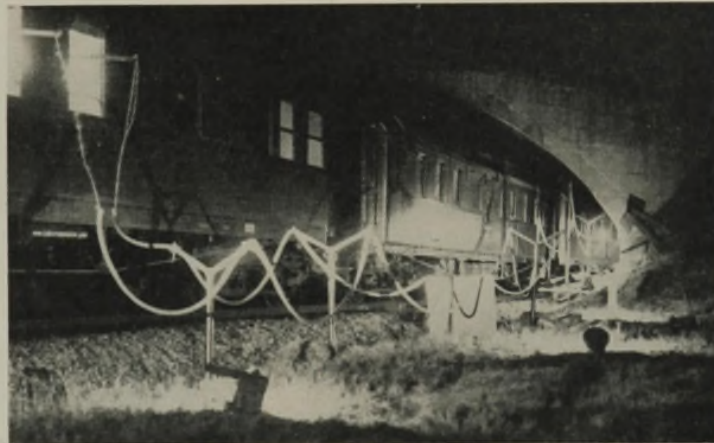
Röntgenaufnahme einer Eisenbahnbrücke bei Nacht.
